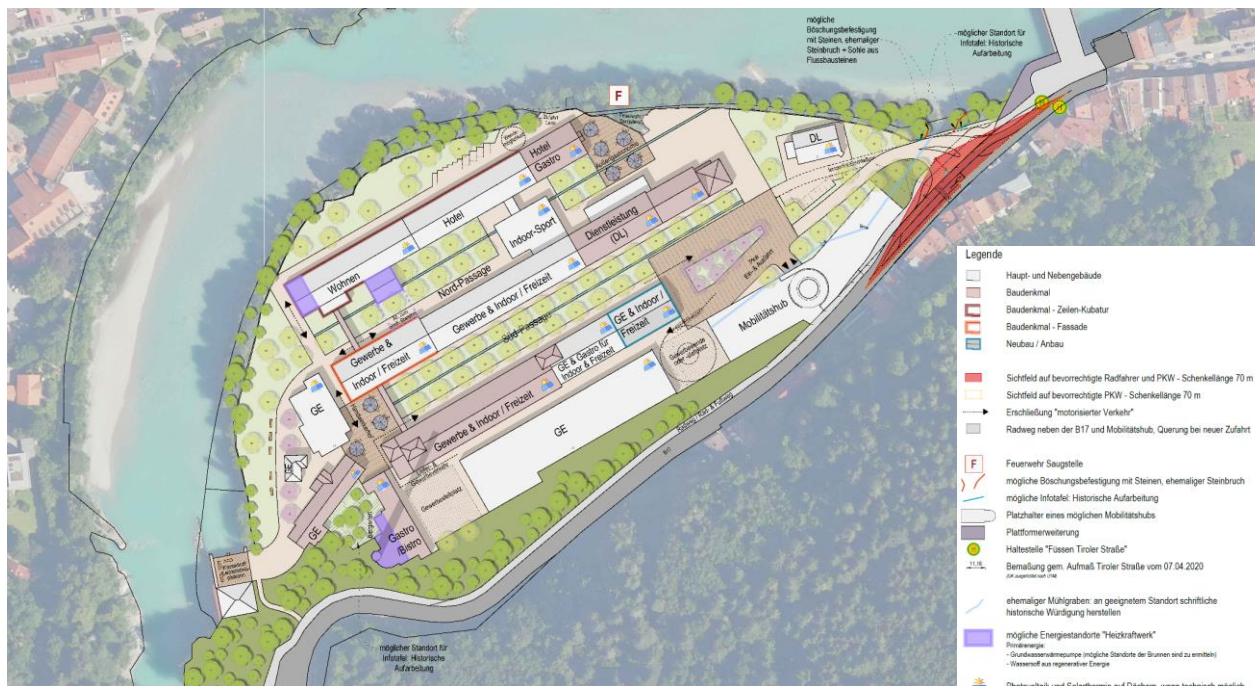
städtebaulicher Masterplan, Büro OPLA, 2023
